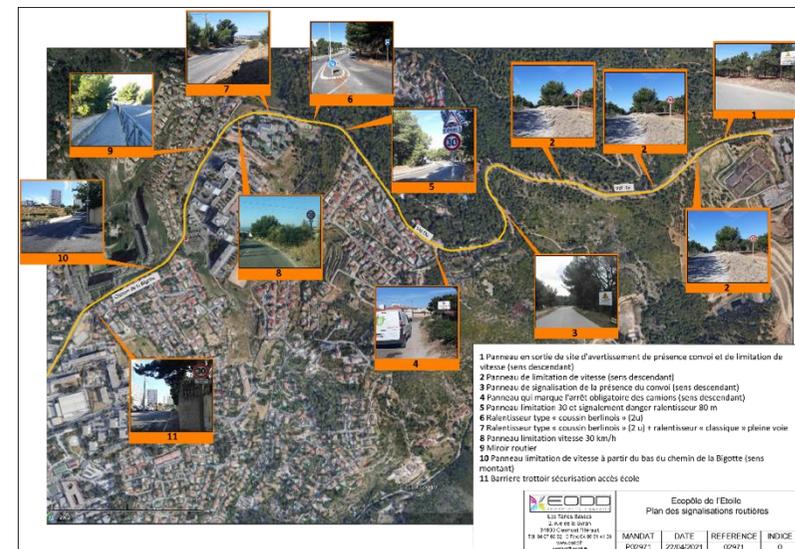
SIGNALIQUER ROUTIERE SUR LA ROUTE D'ACCES AU SITE
